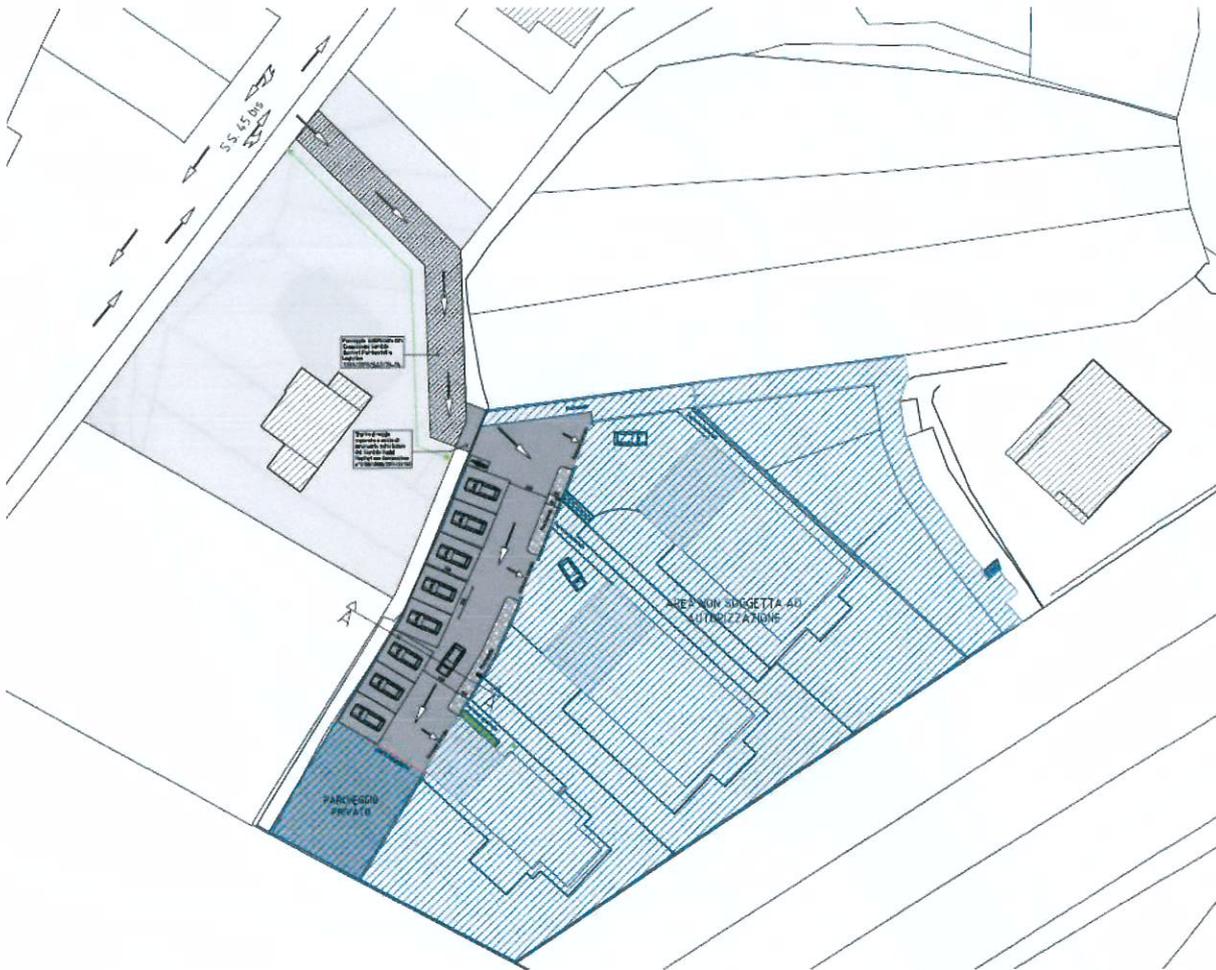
Estratto "Planimetria di lottizzazione di progetto" scala a vista.
